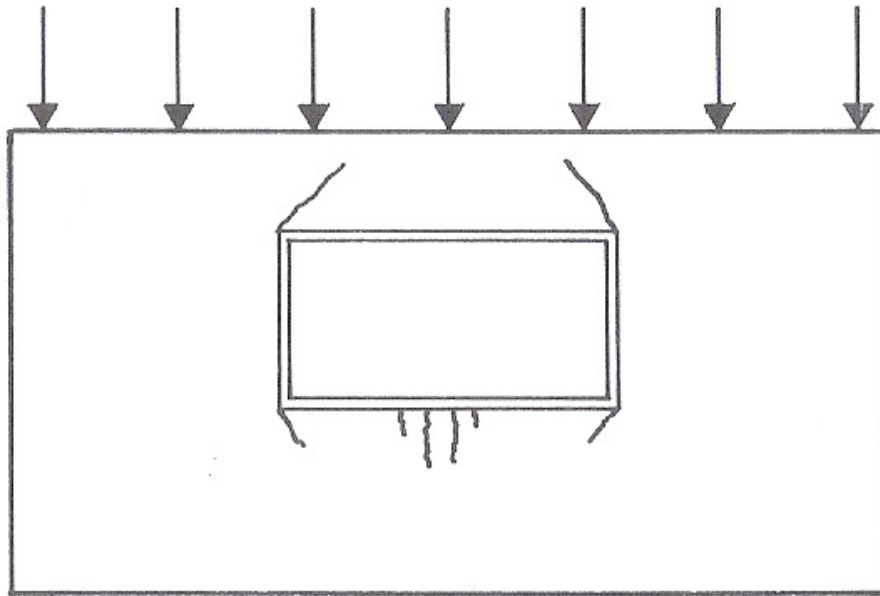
fissuração (teórica) no entorno da abertura (THOMAZ, 1989, p. 66)
